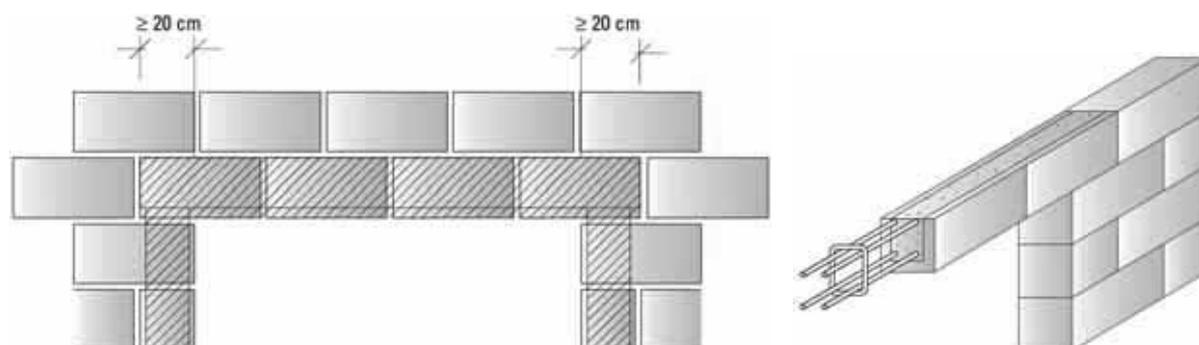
Formación de dintel con piezas especiales para la introducción de armadura y su hormigonado.
